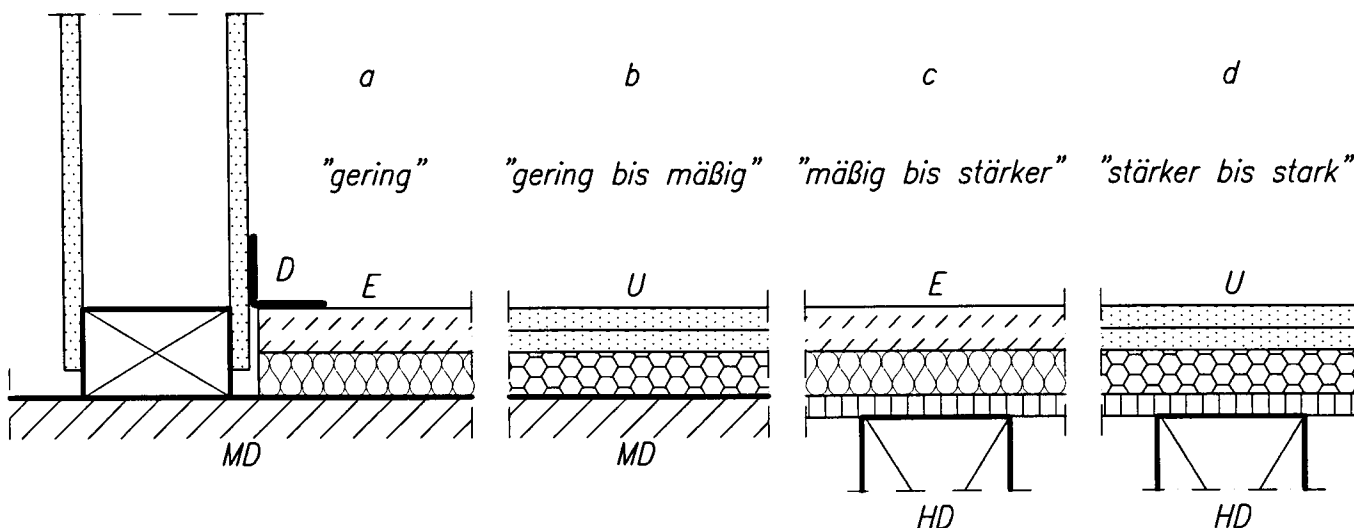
Angenommene mögliche Relativbewegungen zwischen Badfußboden und aufgehender Wand auf Grund der Bewertung nach Tabelle 6.1 für Konstruktionen mit Massivdecke MD oder Holzbalkendecke HD sowie Deckenauflage mit schwimmendem Estrich E oder Unterboden U aus Plattenwerkstoffen (Gipsbauplatten)
